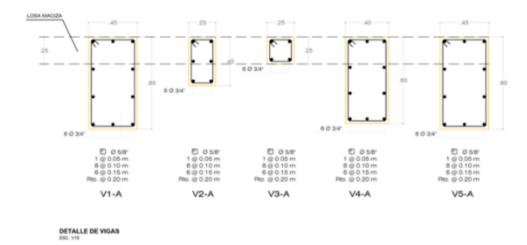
Detalles de Vigas del proyecto Fuente: Elaboración propia
